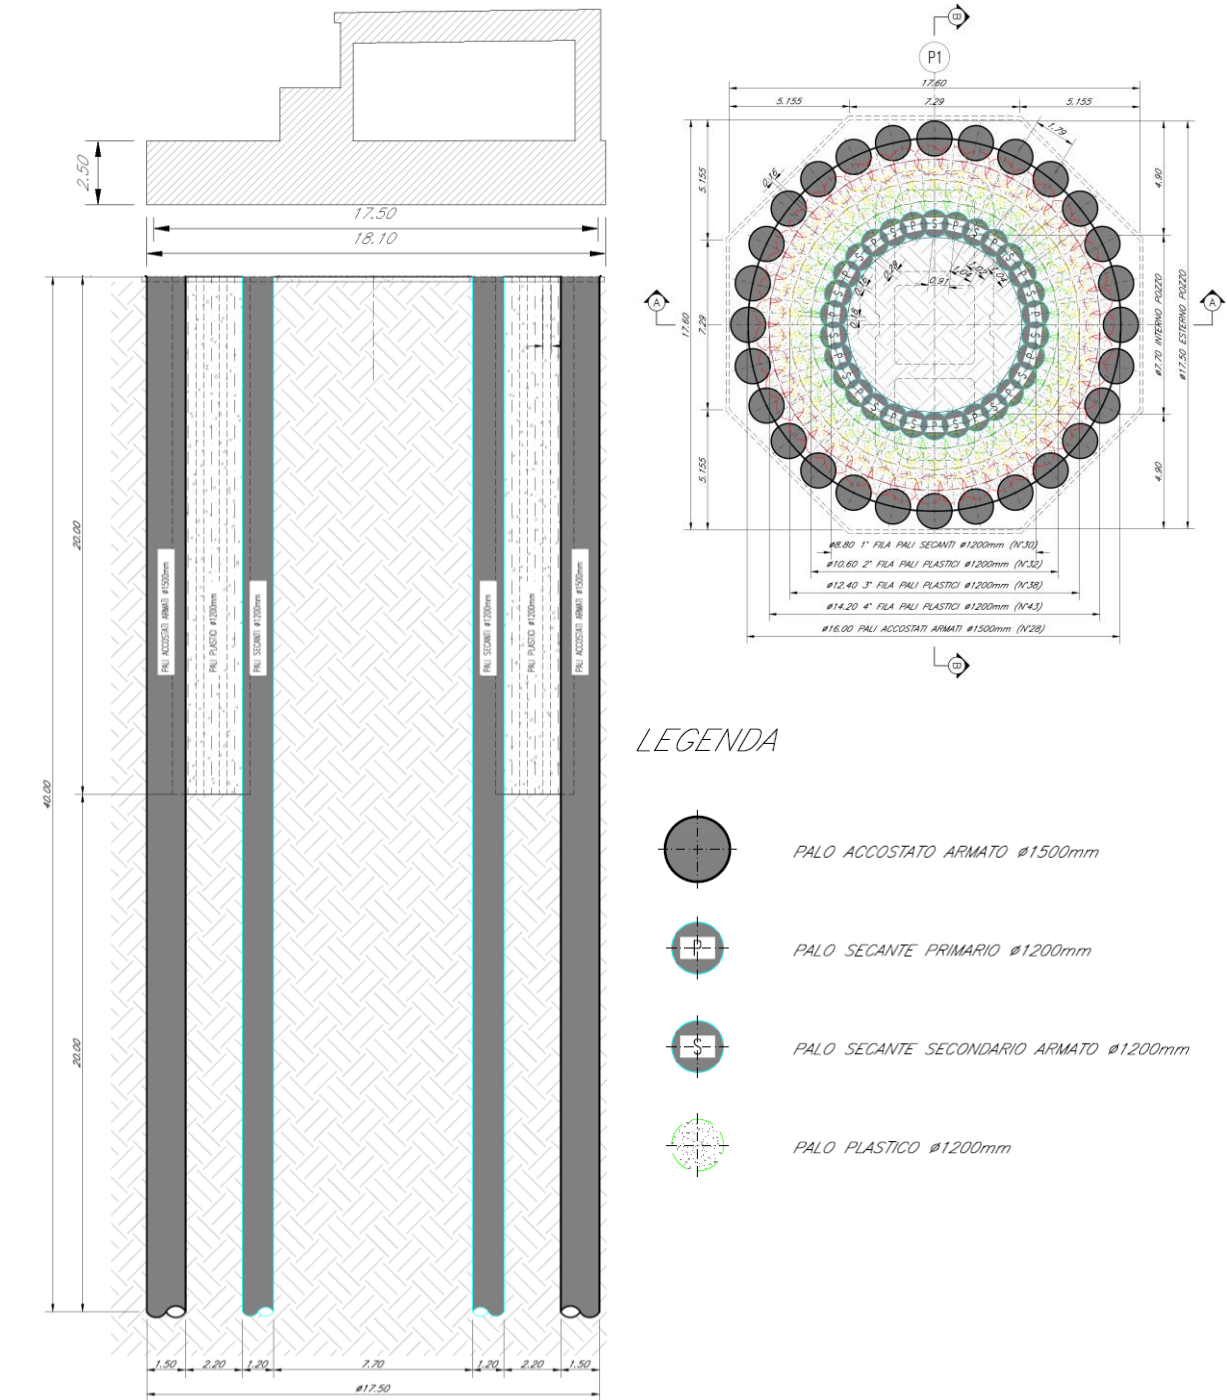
Pianta e sezione longitudinale pozzi strutturali di fondazione Spalla A
